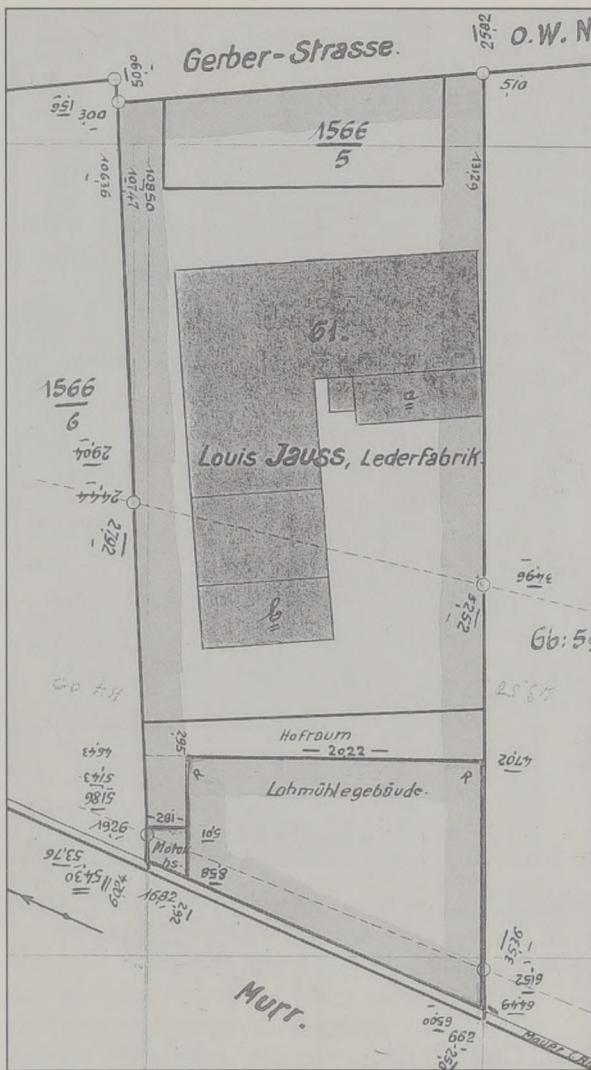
Lageplan mit den auf der Parzelle 1566/4 (Gerberstraße 61) bis 1910 errichteten Gebäuden.
